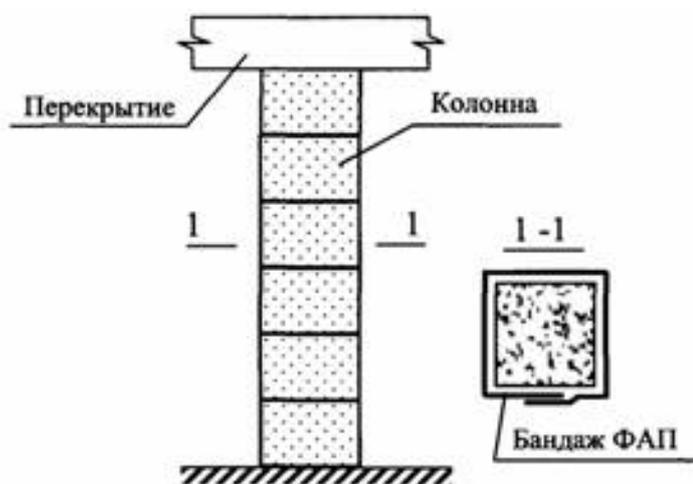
Принципиальная схема усиления колонны фиброармированными пластиками (ФАП)
